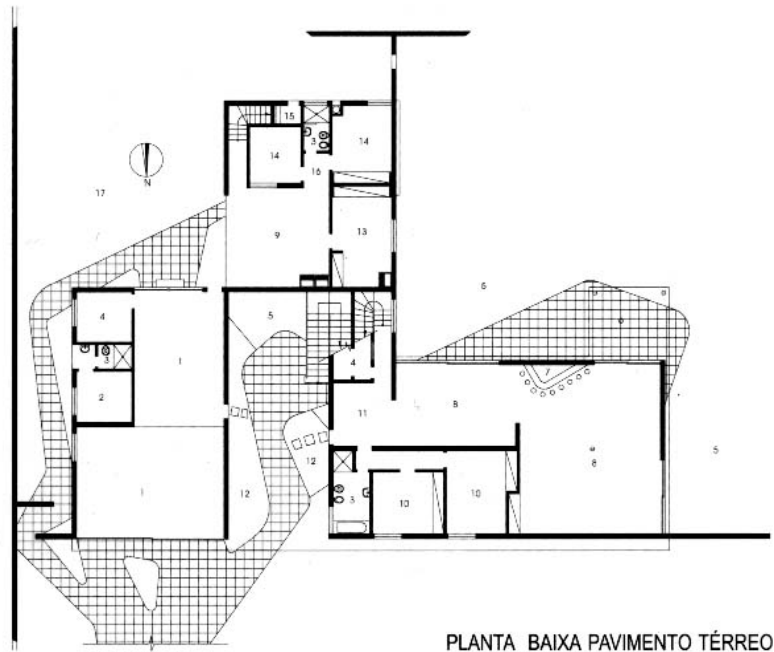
Planta Baixa Pavimento Térreo .Legenda – 1. Garagem 2. Quarto Motorista 3. Banheiro 4. Depósito 5. Jardim 6. Varanda 7. Bar 8. Salão de Jogos 9. Área de Serviço Coberta 10. Quarto 11. Entrada 12. Lago 13. Lavanderia 14. Quarto de Empregada 15. Armário 16. Hall 17. Pátio de Serviço. Fonte: SANTANA, Rodrigo & PUGLIESI, Stella. Arquitetura Moderna em Juiz de Fora: a contribuição de Arthur Arcuri / Rodrigo Santana, Stella Pugliese. Juiz de Fora, FUNALFA, 2002.
